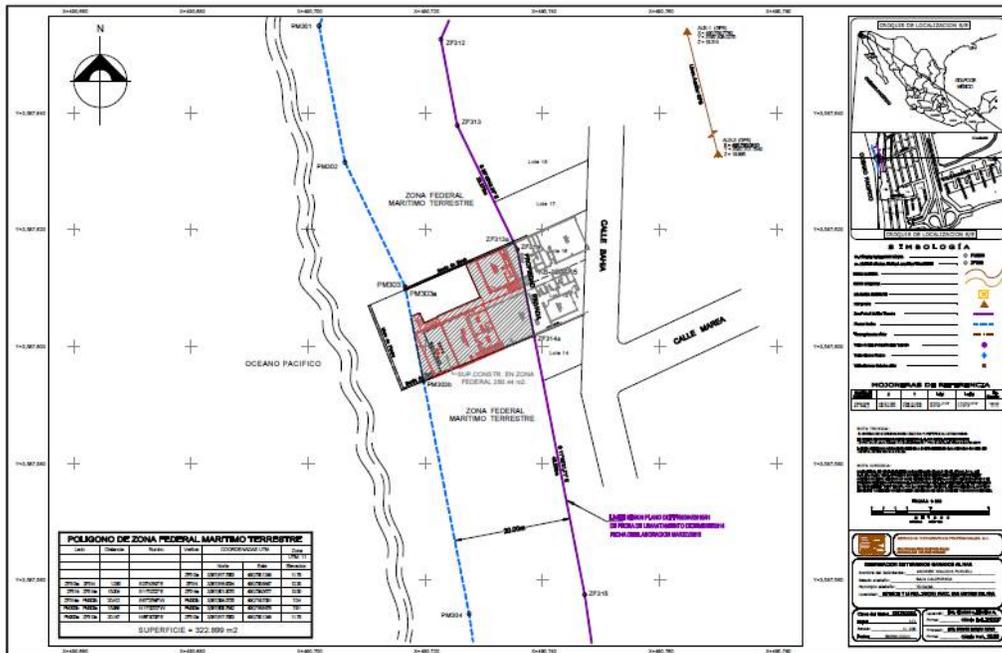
Plano de la superficie total de 322.899 m² y de la superficie a construir de 250.44 m²
